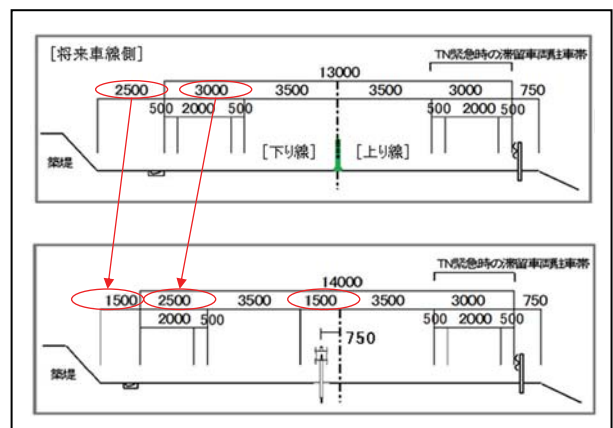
分離 2 車化標準断面図 (工事起点～ニニウ橋)
